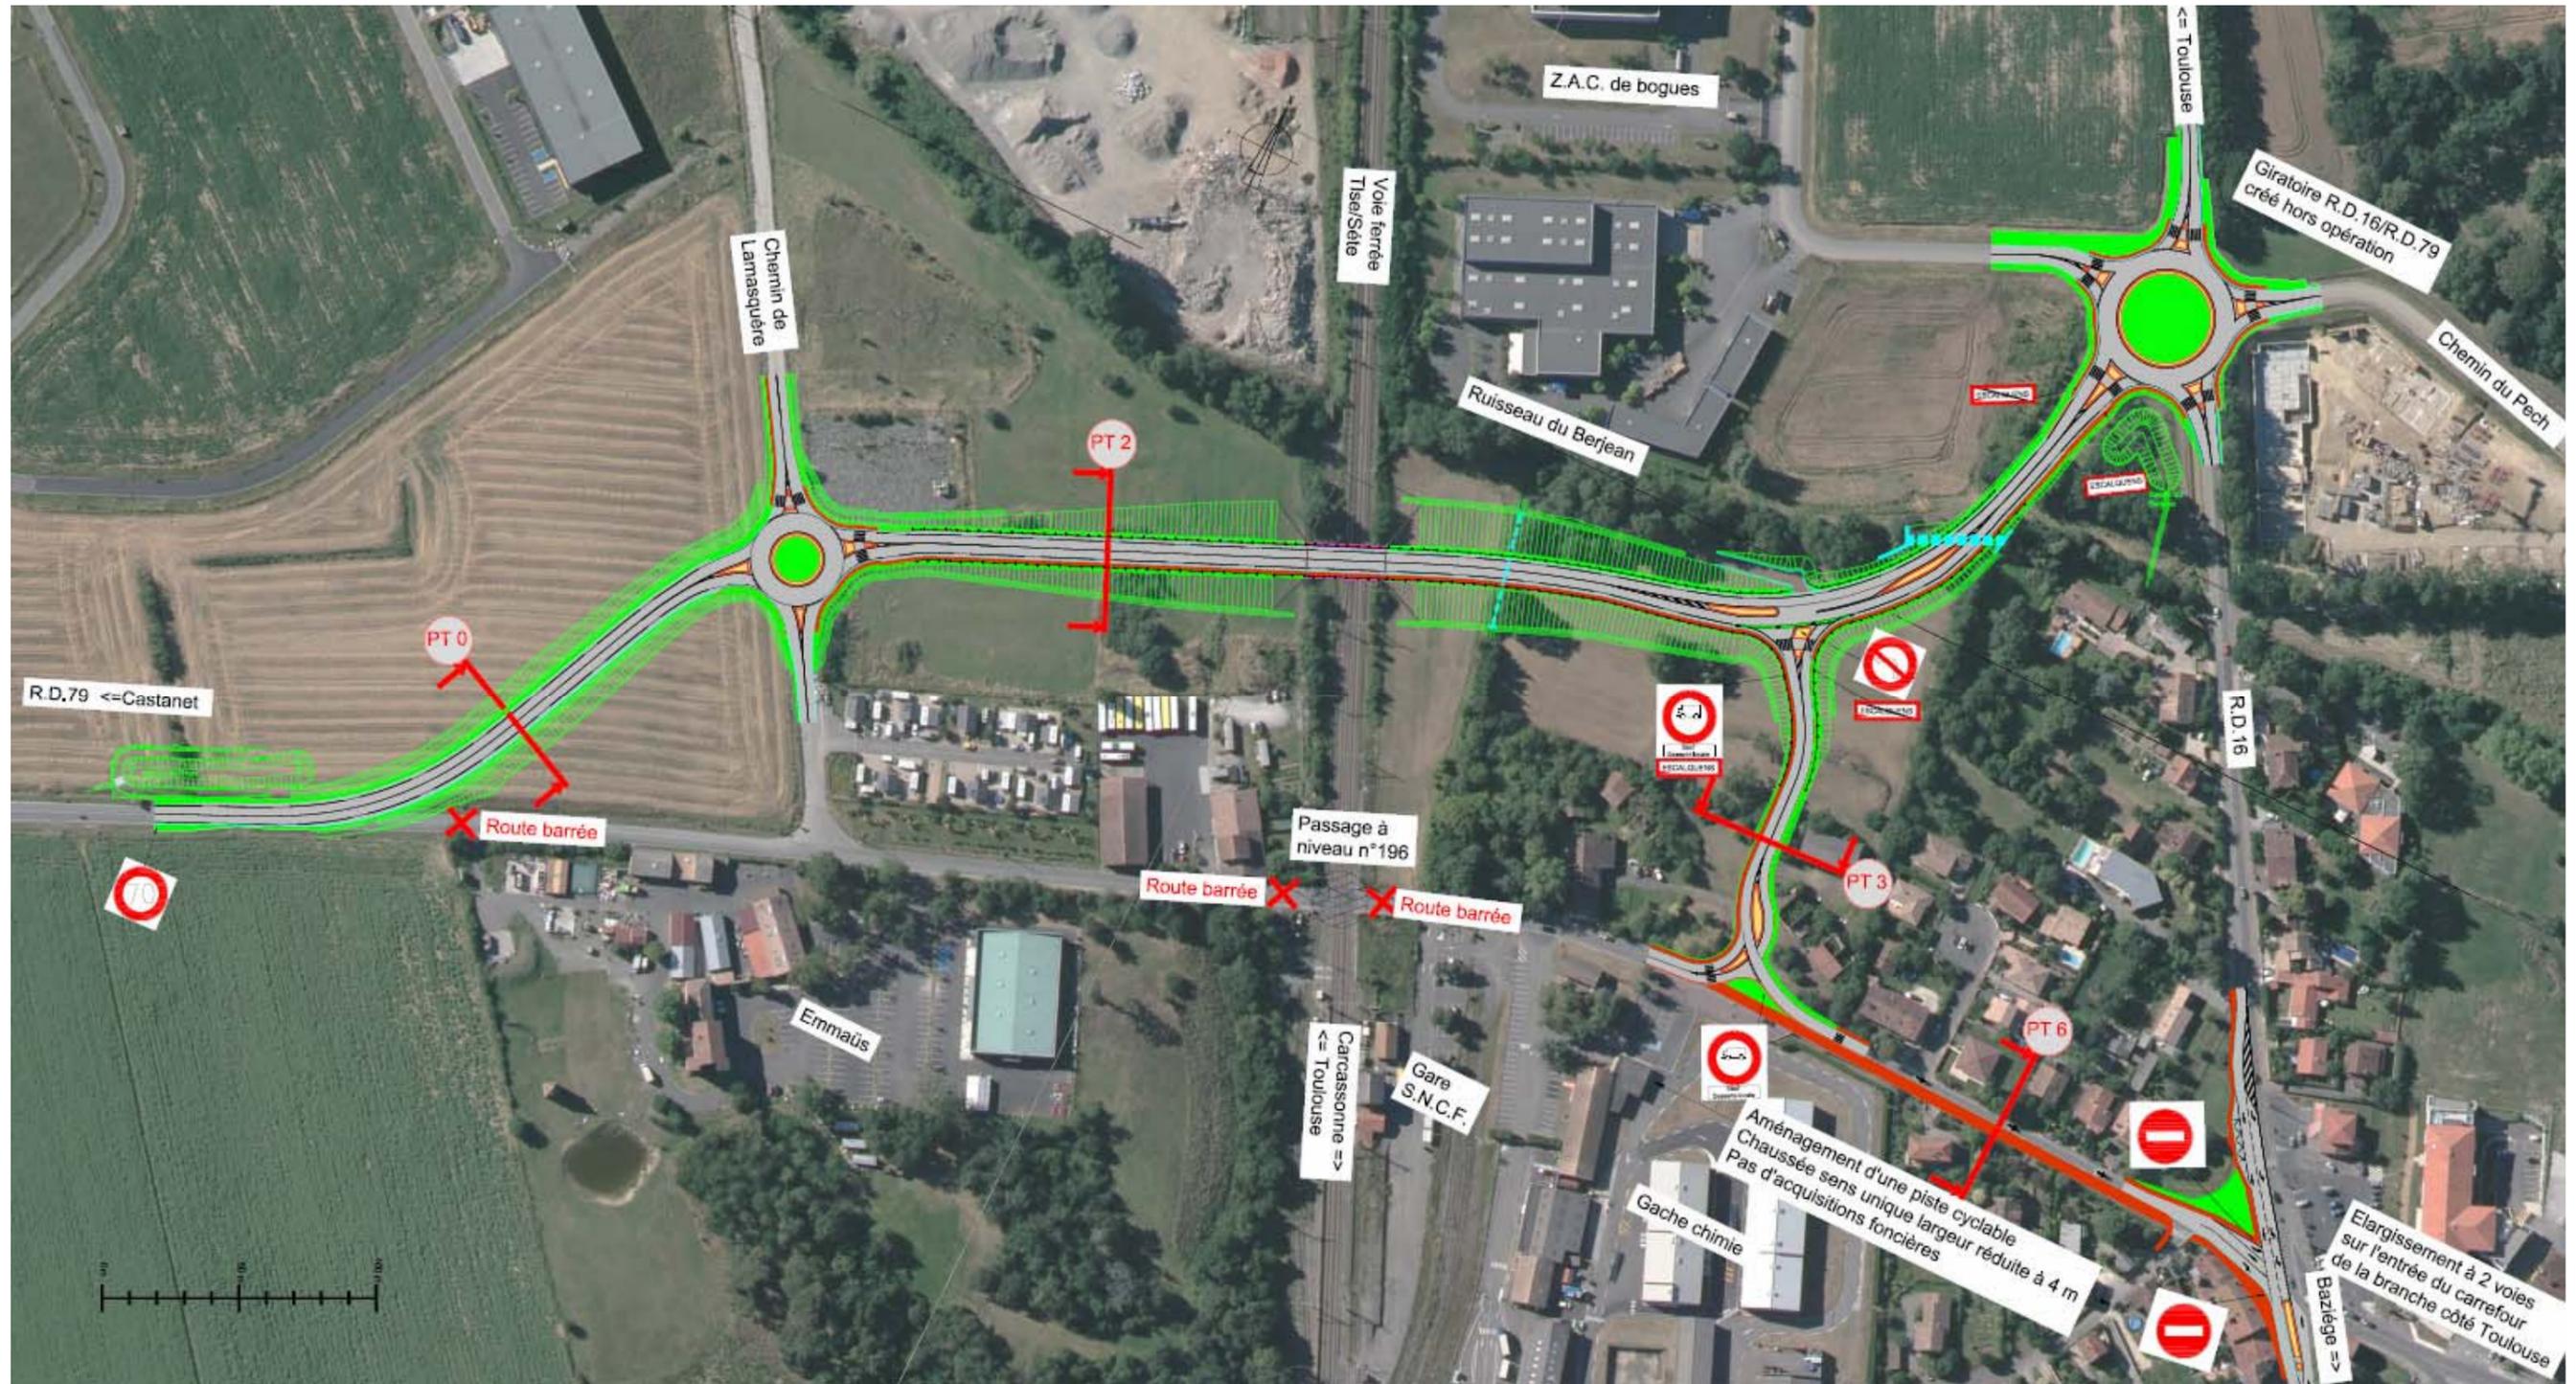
Plan de la variante longue 2 (sens unique du chemin de la gare)
